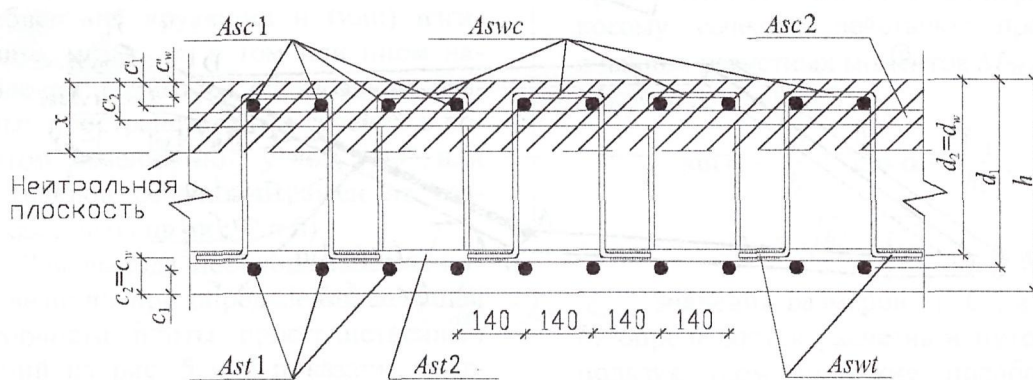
Фрагмент поперечного армирования шестиугольной железобетонной плиты с расположением сжатой зоны в верхней части сечения
